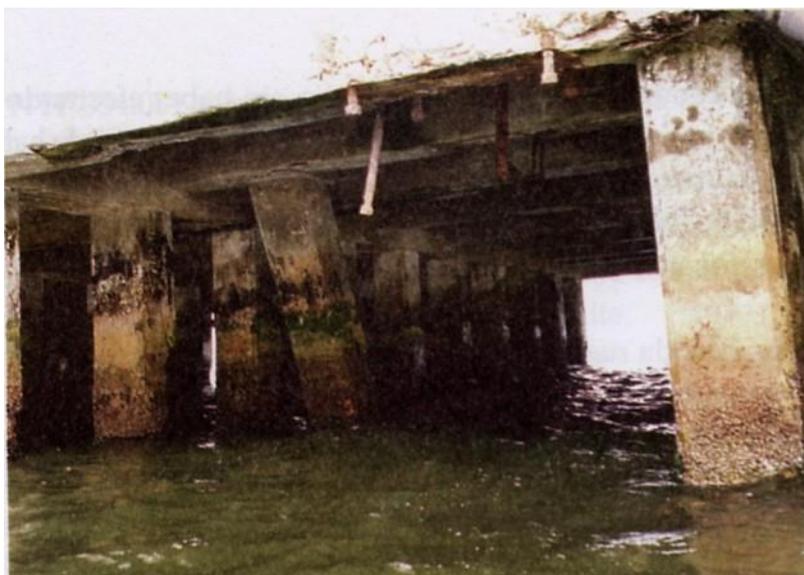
Muestras de corrosión en el muelle de concreto en las zonas de alta y baja marea y en la zona de salpicadura.
